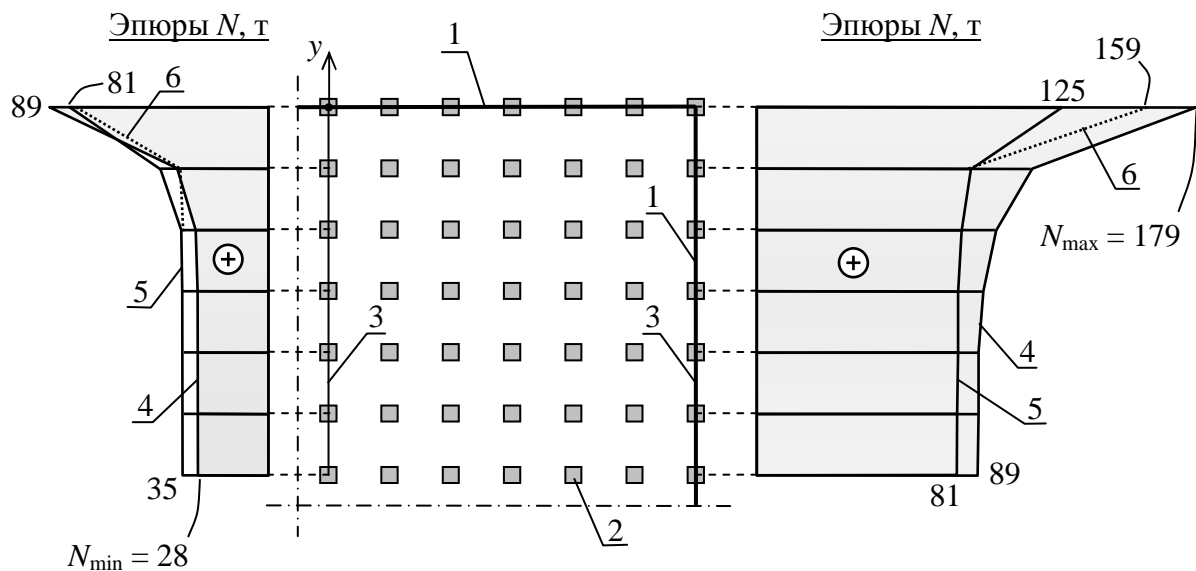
Эпюры вертикальных сжимающих нагрузок на головы свай. 1 — граница фундаментной плиты в расчетной схеме; 2 — голова сваи; 3 — базовая линия эпюры; 4 — эпюра для линейно-упругого грунта; 5 — эпюра для кулоновского грунта; 6 — эпюра для модели грунта как системы упругих связей
